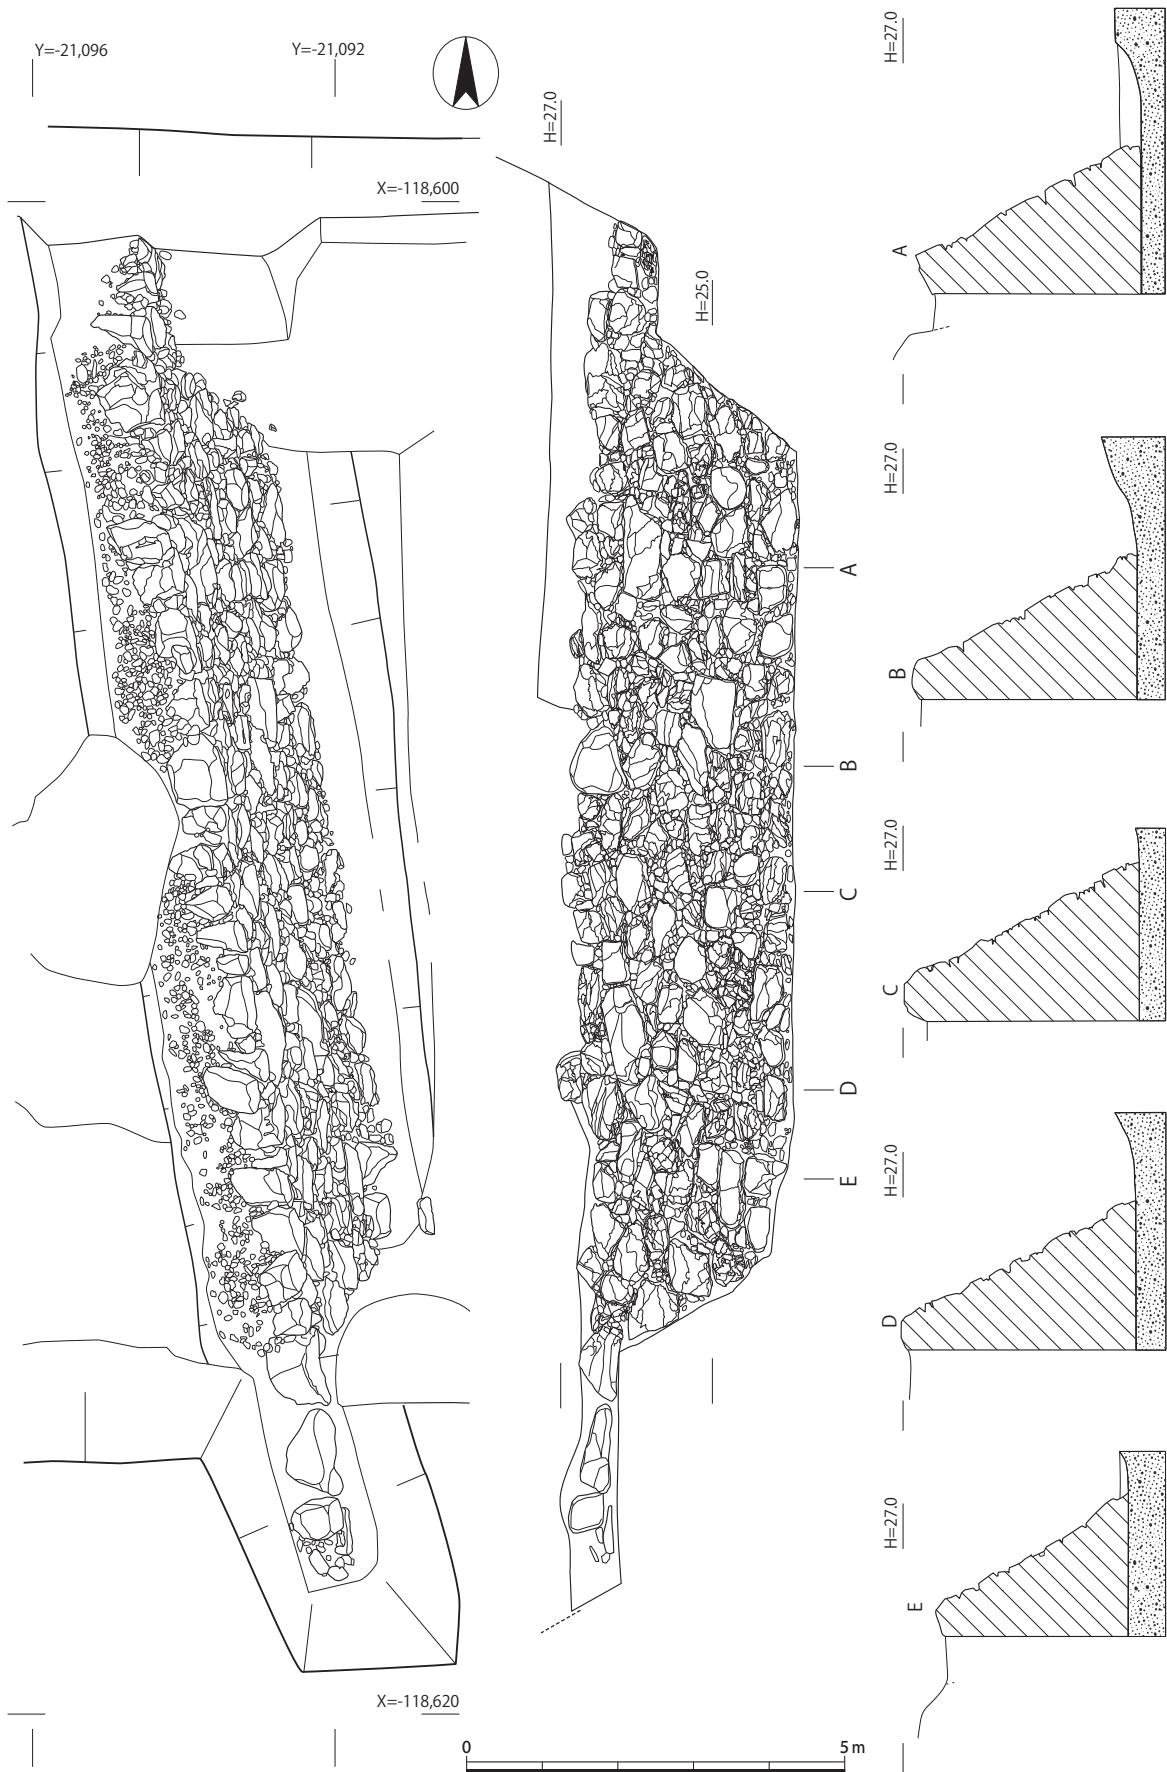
No.15-1調査 石垣平面・立面・断面図 (1 : 100)
